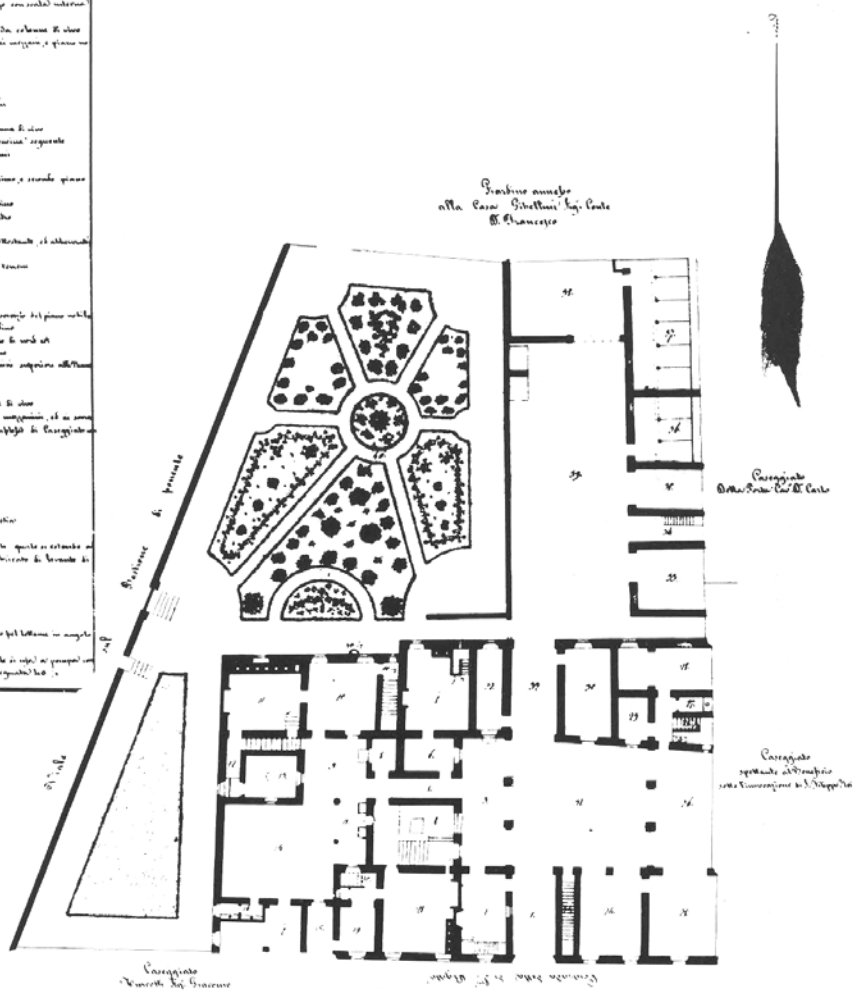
Pianta dell'edificio seicentesco preesistente al progetto antonelliano
